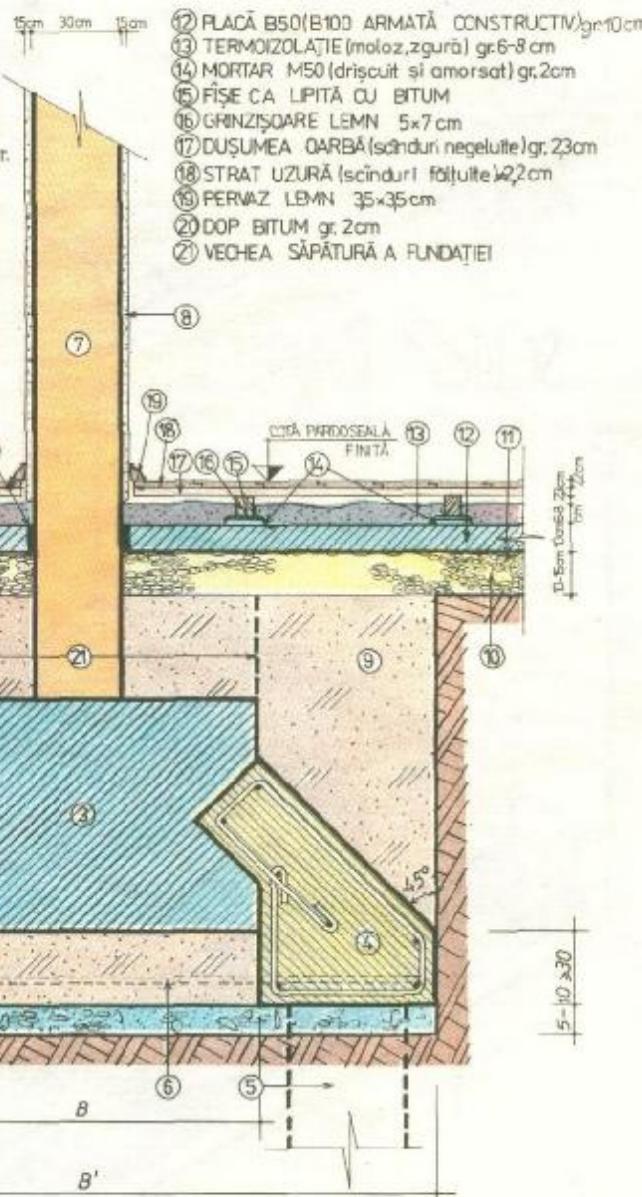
Consolidarea fundației prin lărgirea bazei fundației existente prin grinzi laterale de beton armat (așezate pe piloți). Secțiune transversală:
